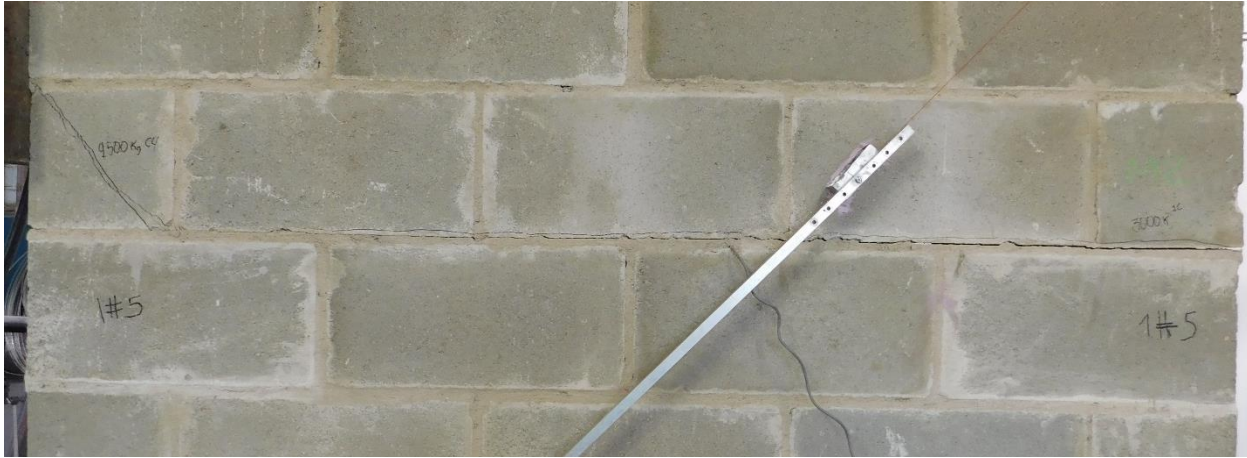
Fisuración y modo de falla del muro MC-1#5/60
